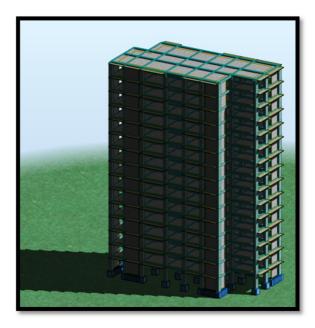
Vue en plan en 3D dans notre bâtiment
